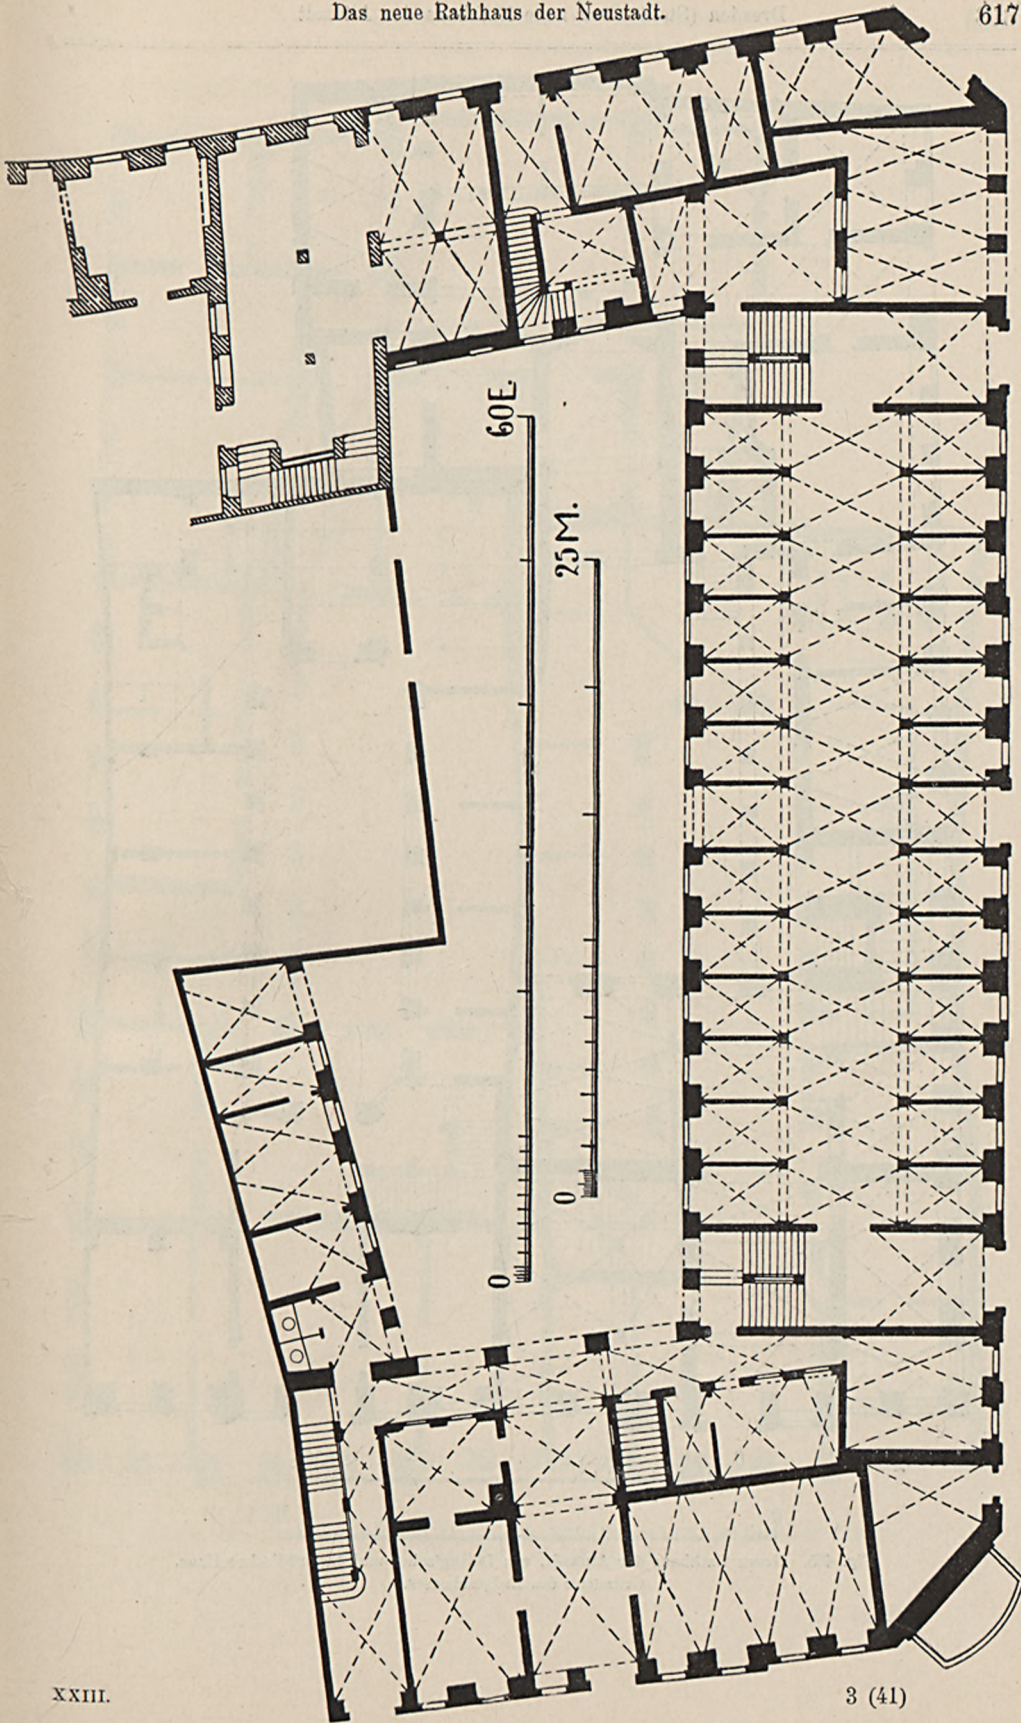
Neues Rathhaus der Neustadt. Grundriss des Erdgeschosses.
